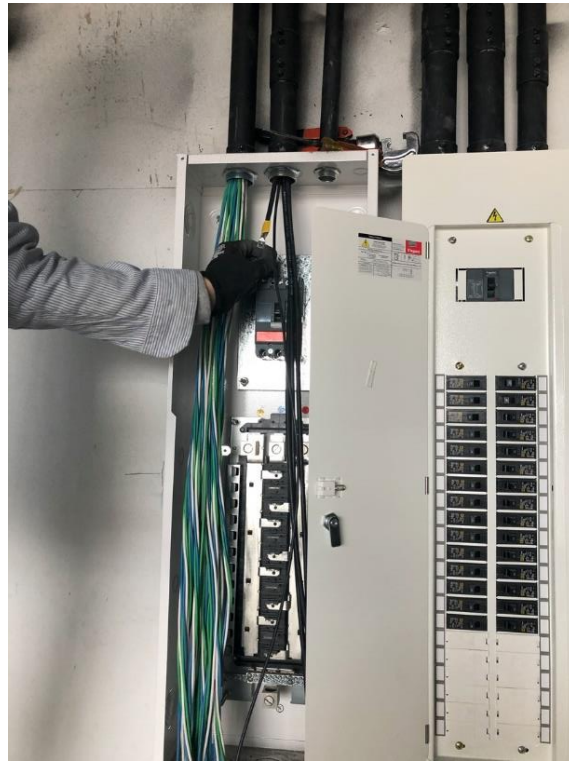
Infraestructura de tubería para llegadas de tableros
